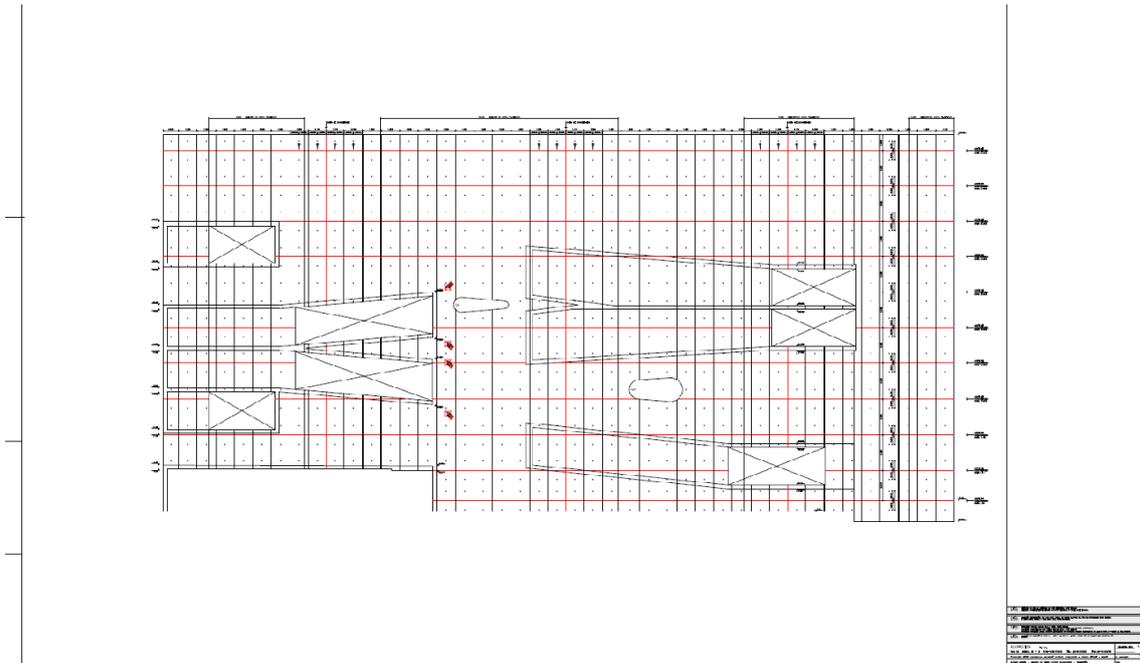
Facha Norte Alçada de Parede Planificada Paginação
